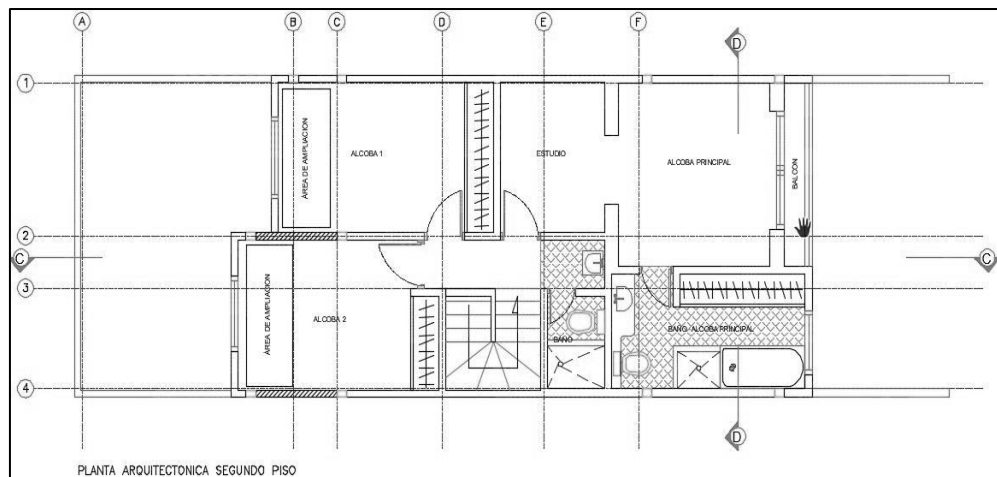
Planta del segundo piso. Plano del propietario Fuente propia
